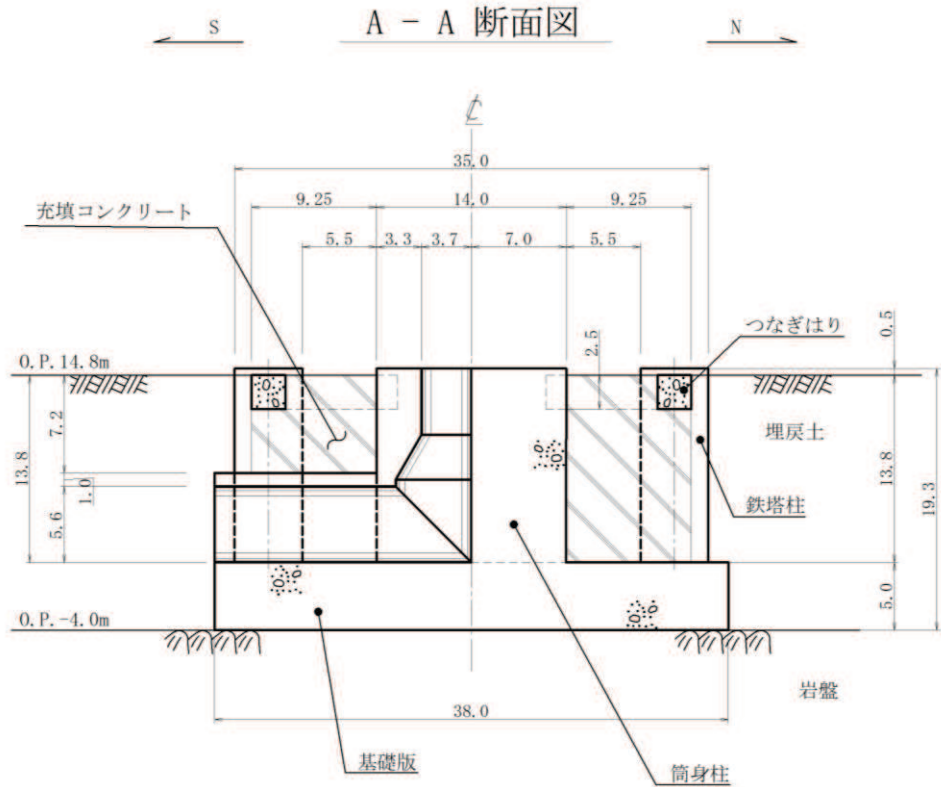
排気筒基礎断面図 (A-A 断面, NS 断面) (単位 : m)
